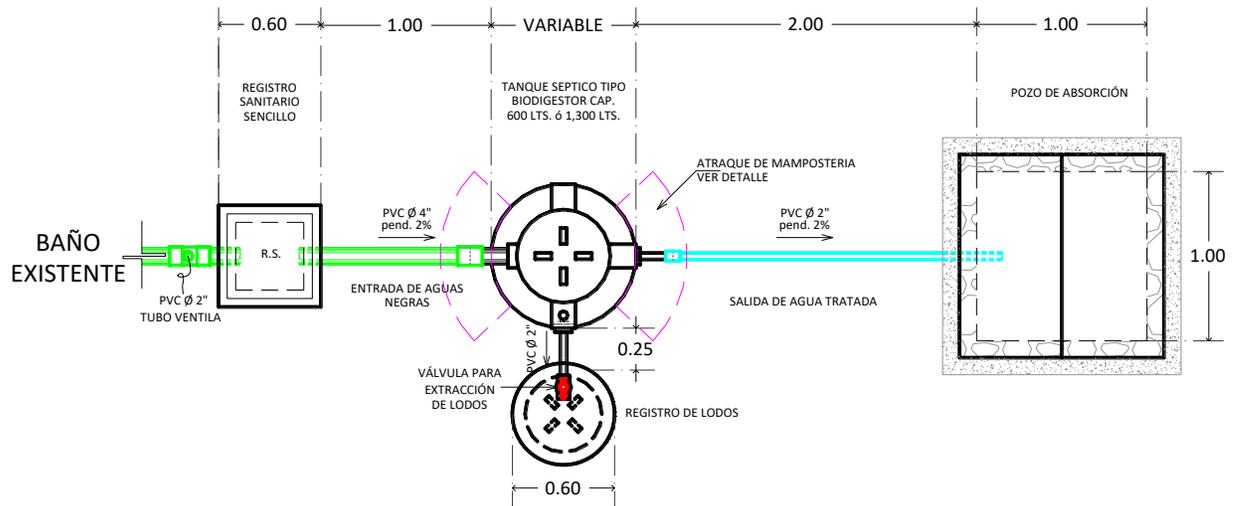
Instalación sanitaria de tratamiento. Módulo de Saneamiento "B" - Vista en planta.
